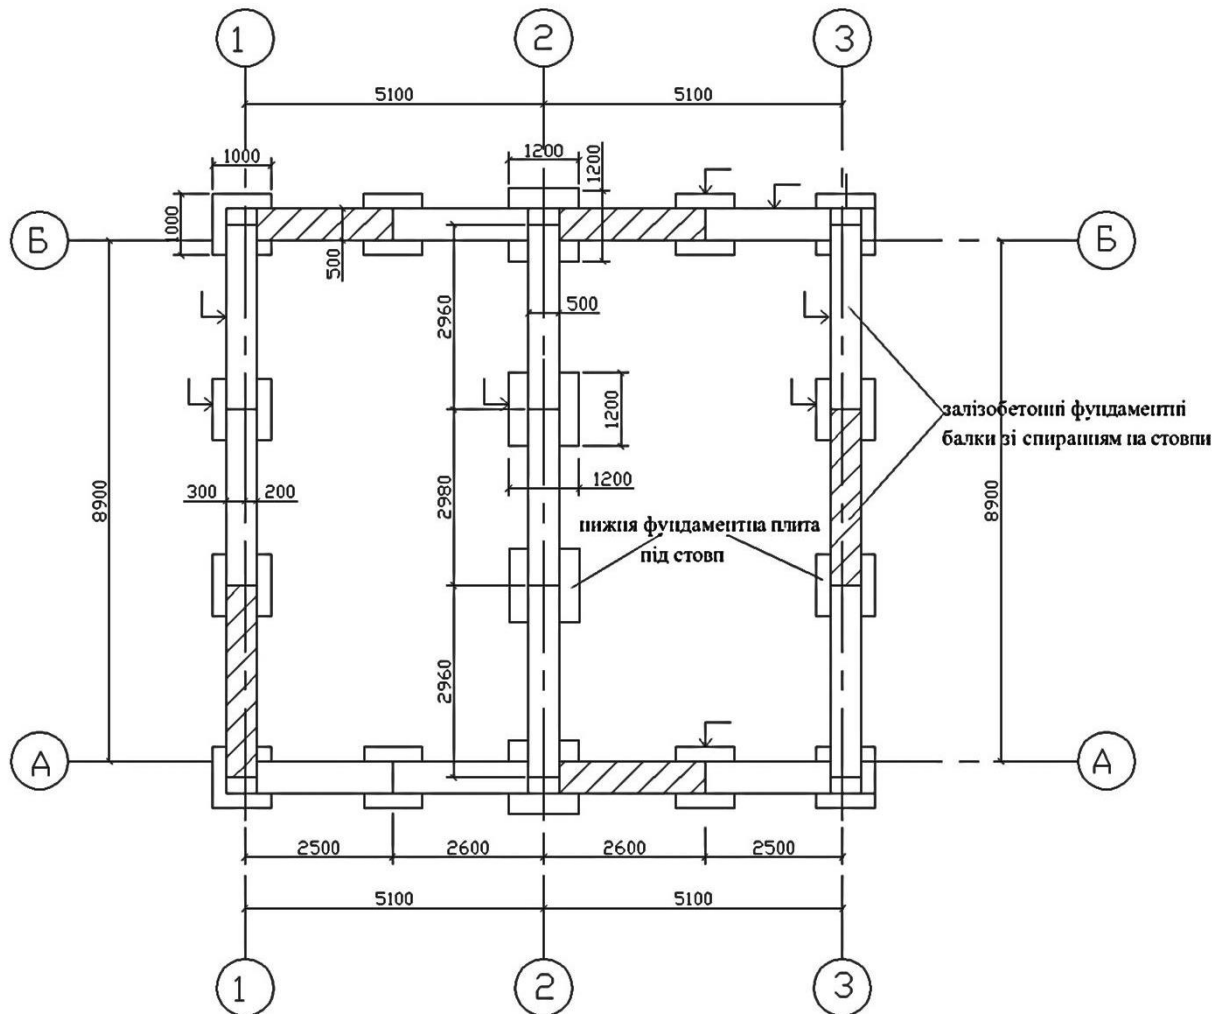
Приклад зображення стовпчастого фундаменту (для кращого розуміння деякі залізобетонні фундаментні балка виділені штриховкою)
